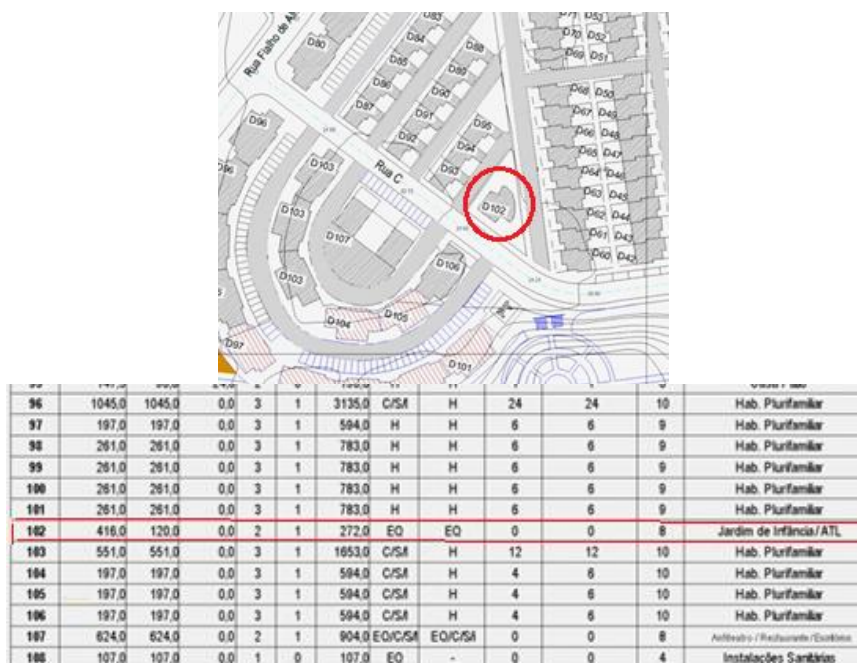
Extrato da Planta de Implantação e respetiva legenda.
